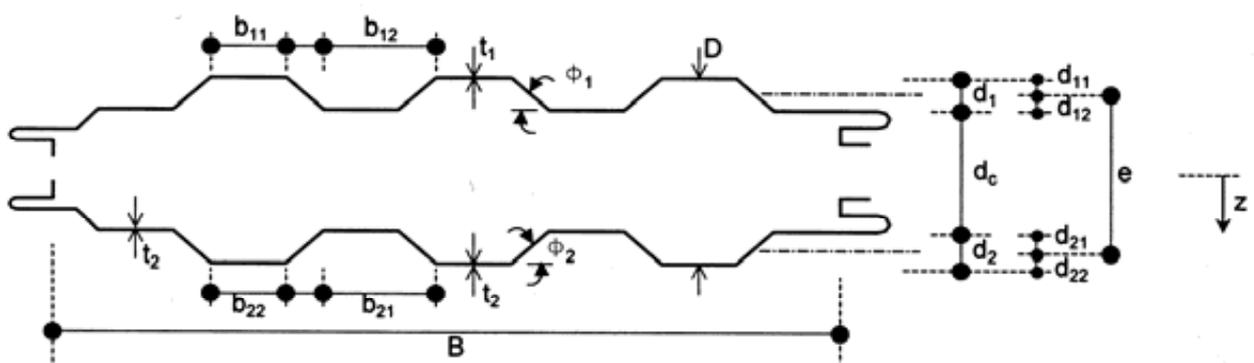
b) — Elementquerschnitt — profilierte Deckschicht und Werkstoffeigenschaften eines Sandwichelements
